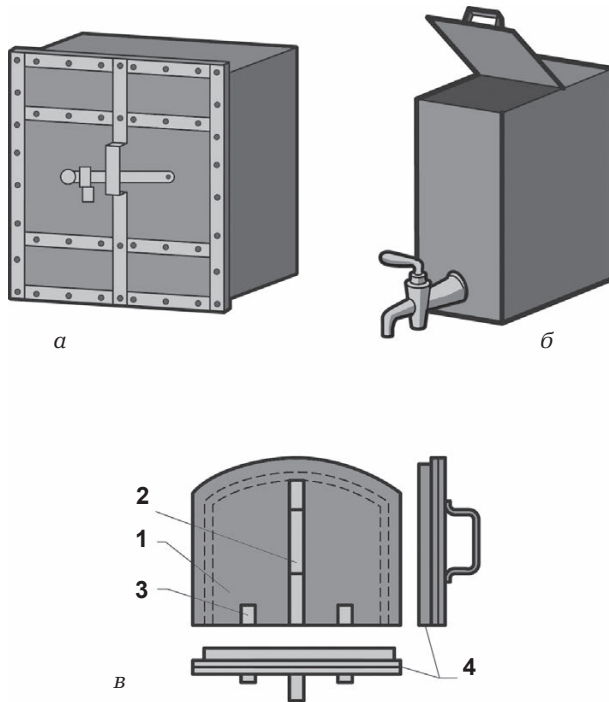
Печные приборы: а — духовой шкаф; б — водогрейная коробка; в — печная заслонка: 1 — полотно; 2 — ручка; 3 — лапка из полосовой стали; 4 — листовой асбест
